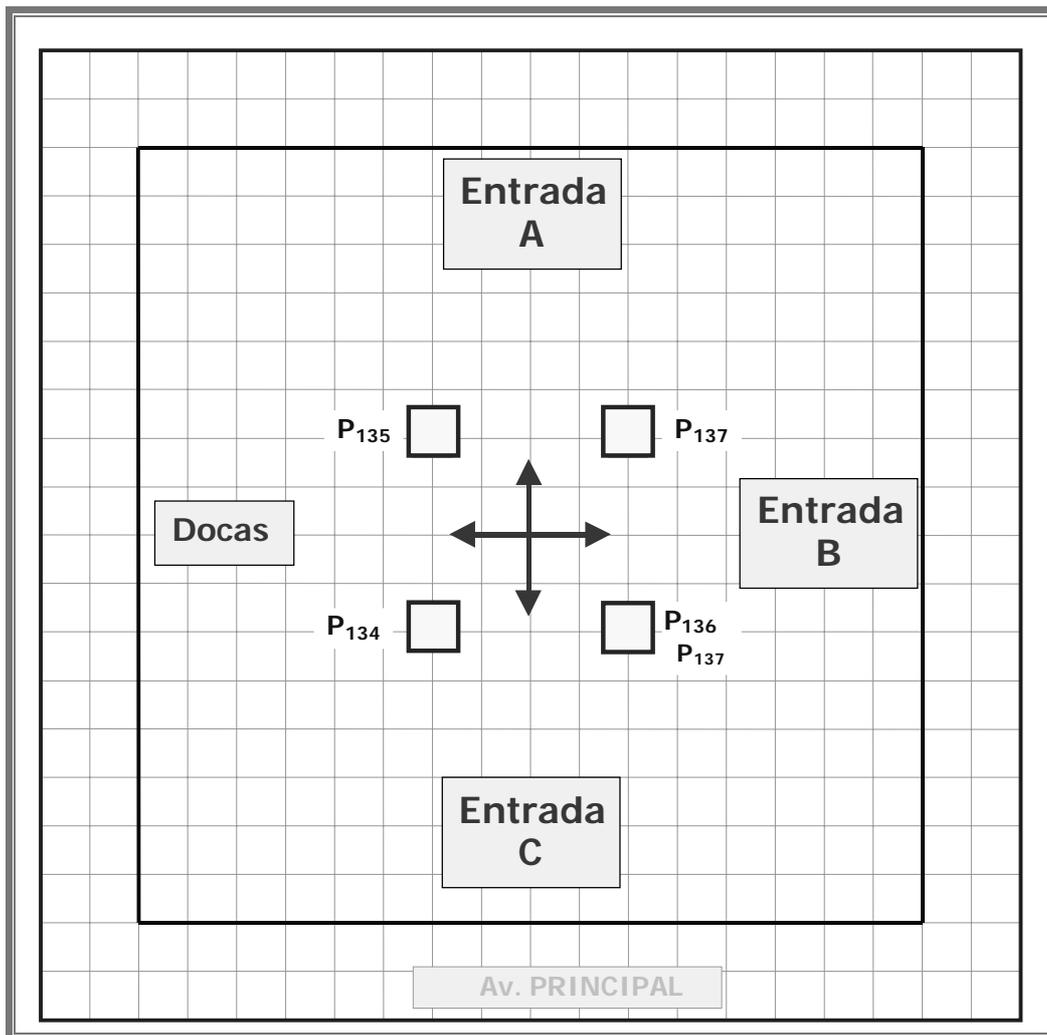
Localização dos quatro pilares da praça central do Condomínio.
